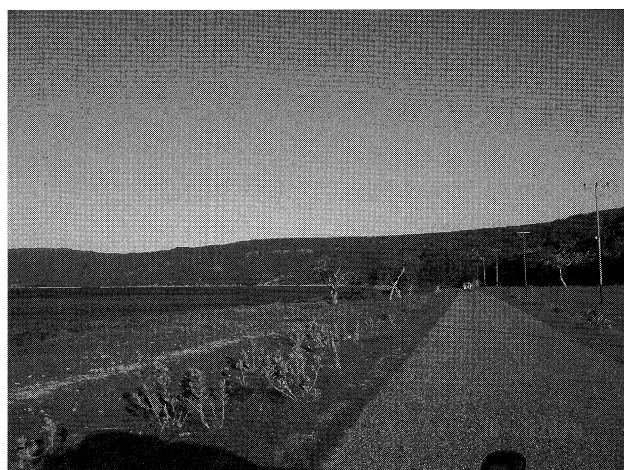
島北部の幹線道路 (A 01, Lautem~Com 間)
